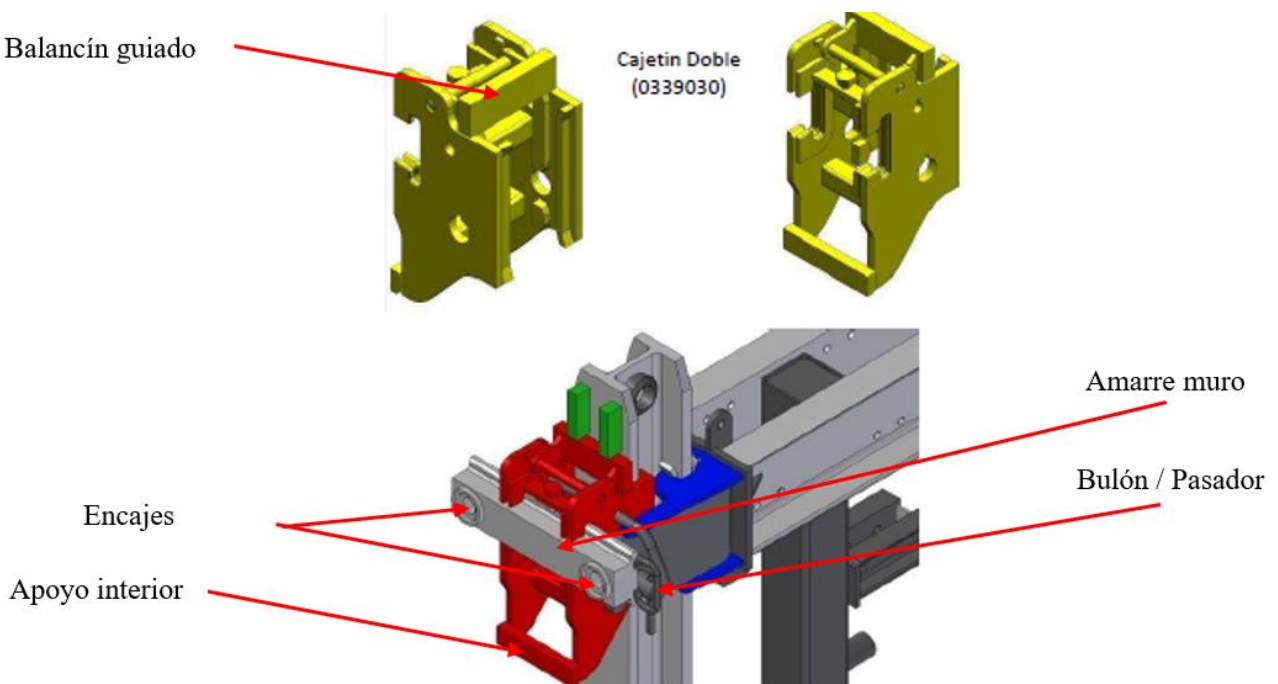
Detalle de cajetín doble, para hacer el anclaje al muro. Adaptada de: Ulma Construction, *Consolas autotrepantes*.
